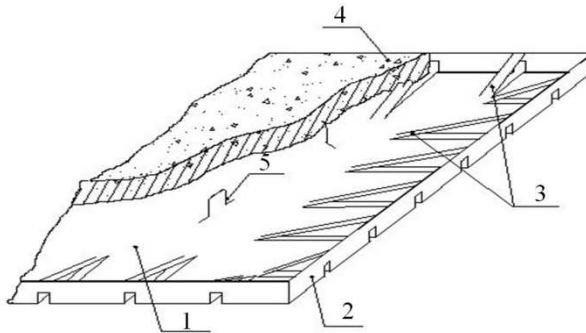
Фрагмент плити із зовнішнім армуванням
